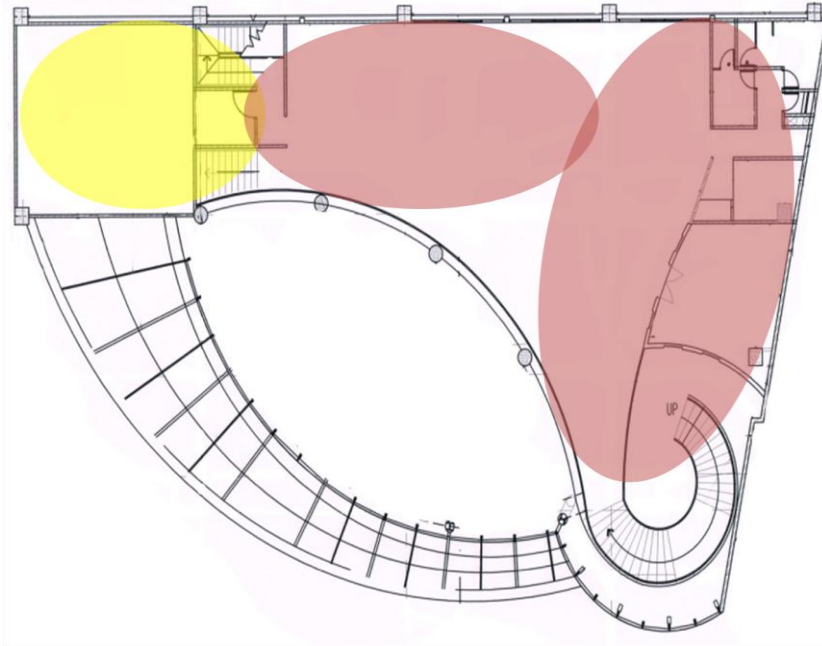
Zoning dan Grouping Alternatif 2 Lantai 2
